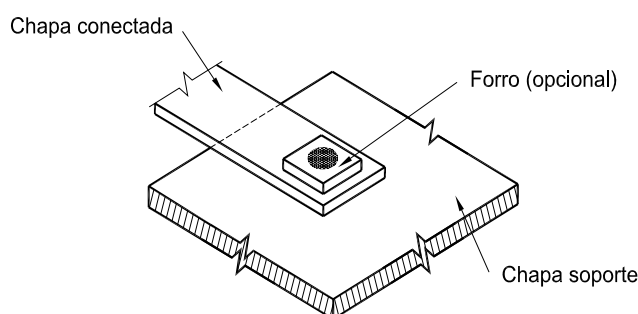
a. Soldadura de arco por puntos con forro
